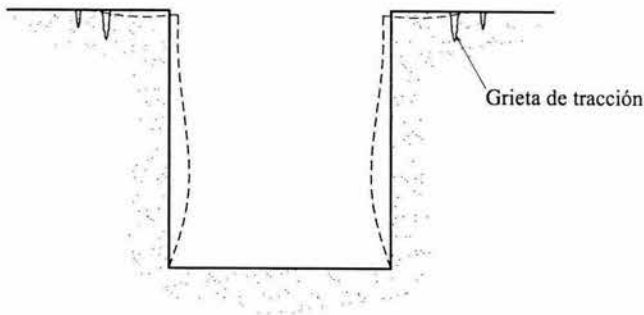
GRIETAS DE TRACCIÓN EN UNA EXCAVACIÓN ABIERTA
